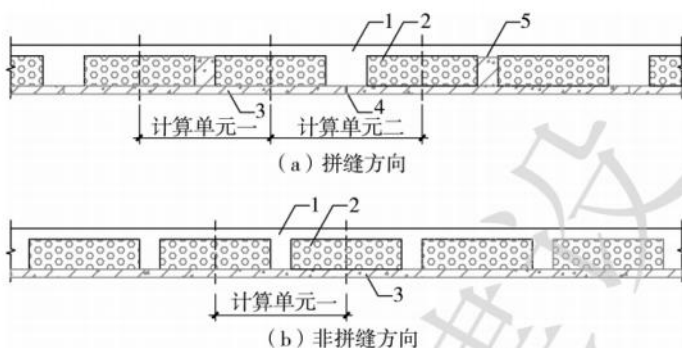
预制带肋底板空心楼板横截面计算单元示意图
